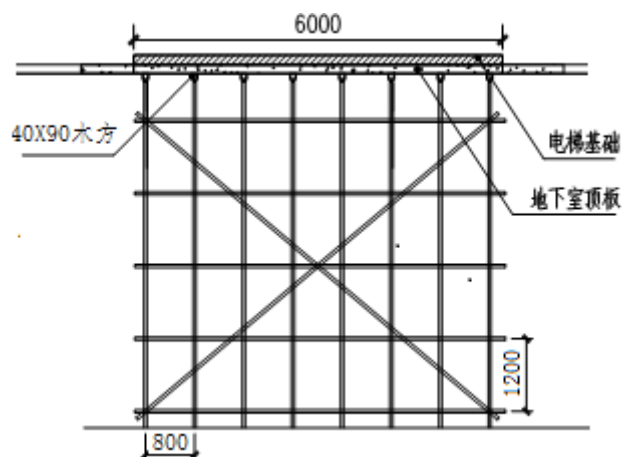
5#楼施工电梯基础在负一层钢管支撑加固示意图
